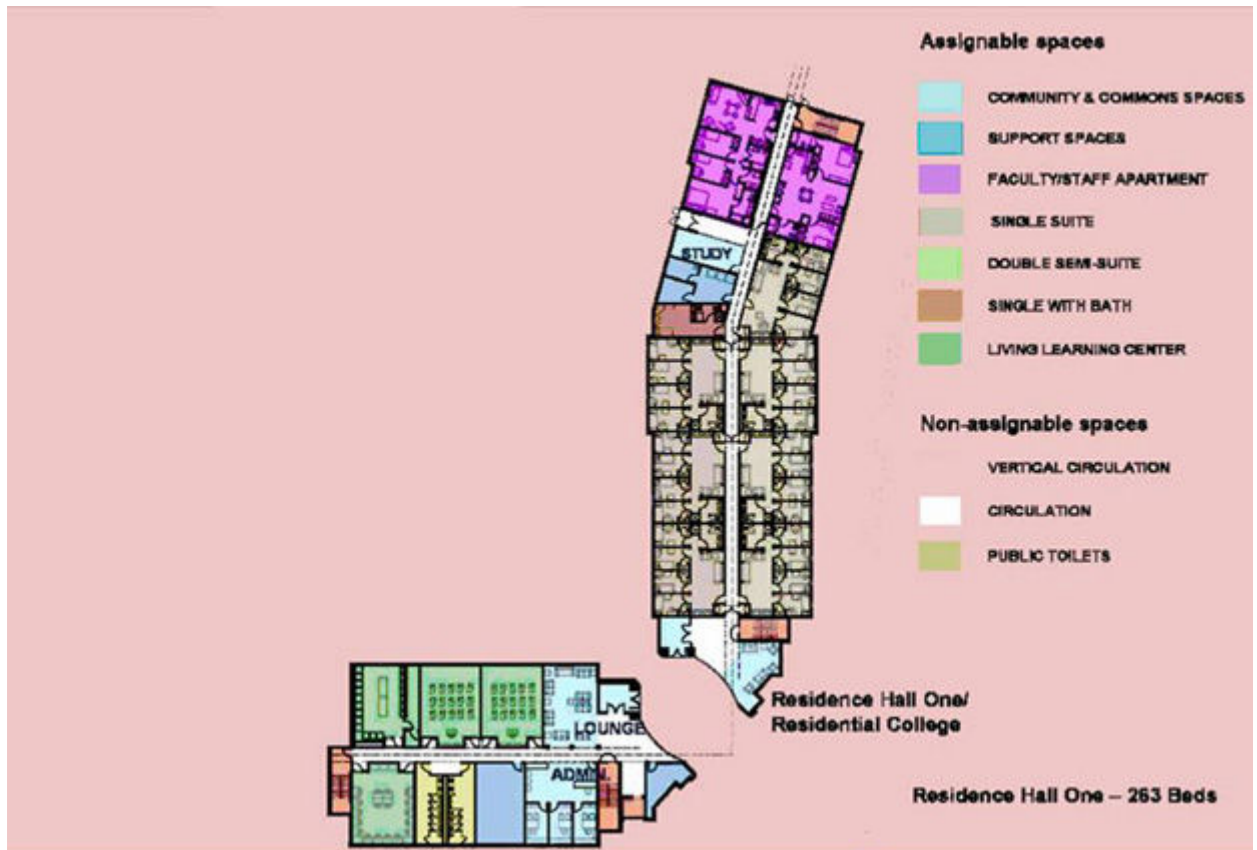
Planta baixa do pavimento térreo (RESCOLLEGE, 2010).
